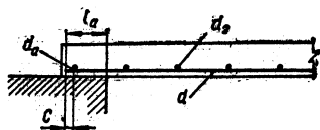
Анкеровка сварных арматурных сеток на свободных опорах.
